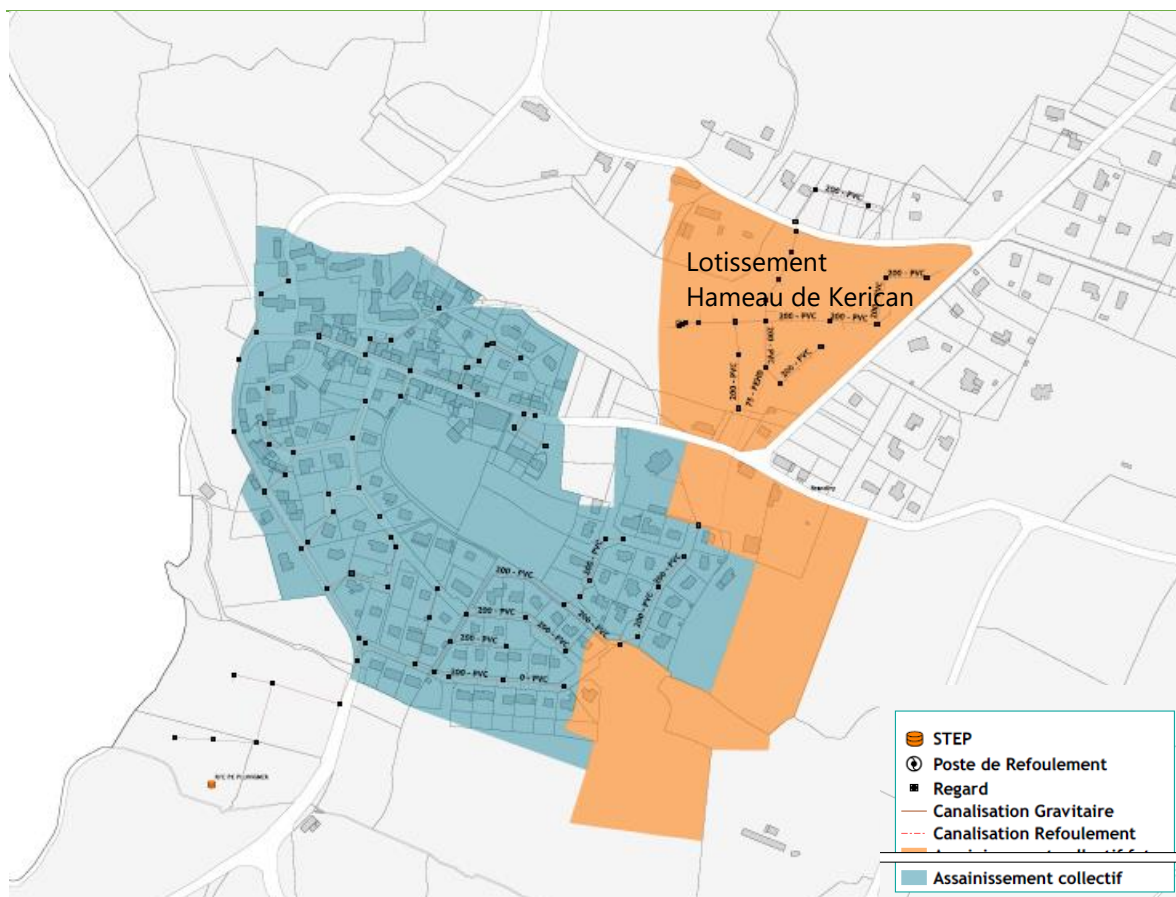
Plan des réseaux eaux usées de Brandivy (source GMVA – plan du zonage d'assainissement)
